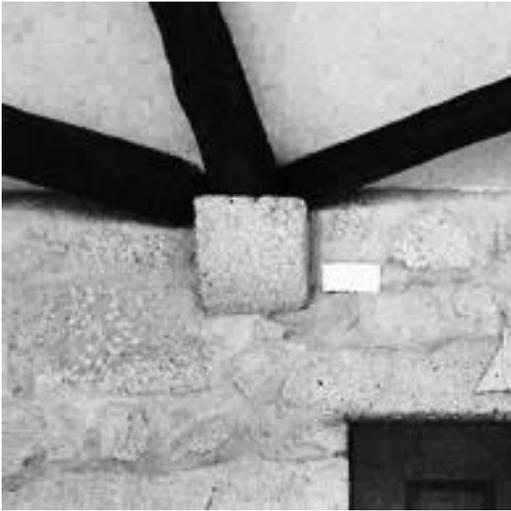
Fotografia de cachorros de pedra com vigas de madeira
